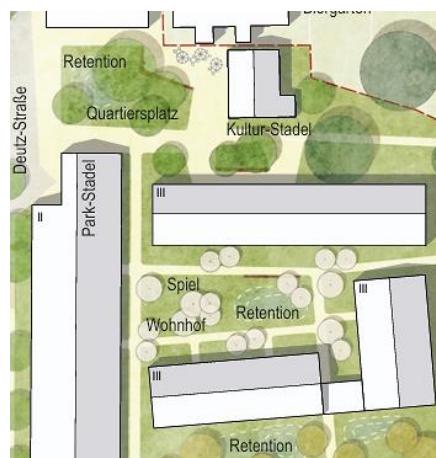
Plan d'une des zones de rétention (LAUX Architekten, m-g-k)
